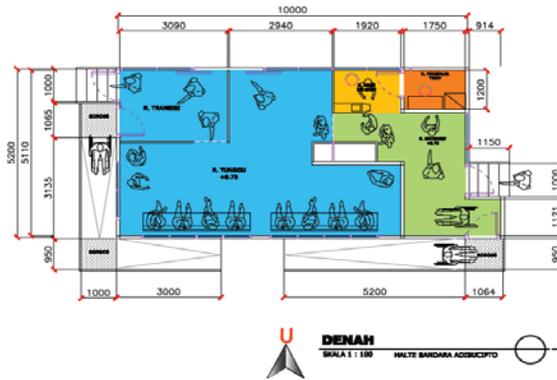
Konsep denah halte baru (*re-design*) dengan sistem hidrolik (usulan 1)
